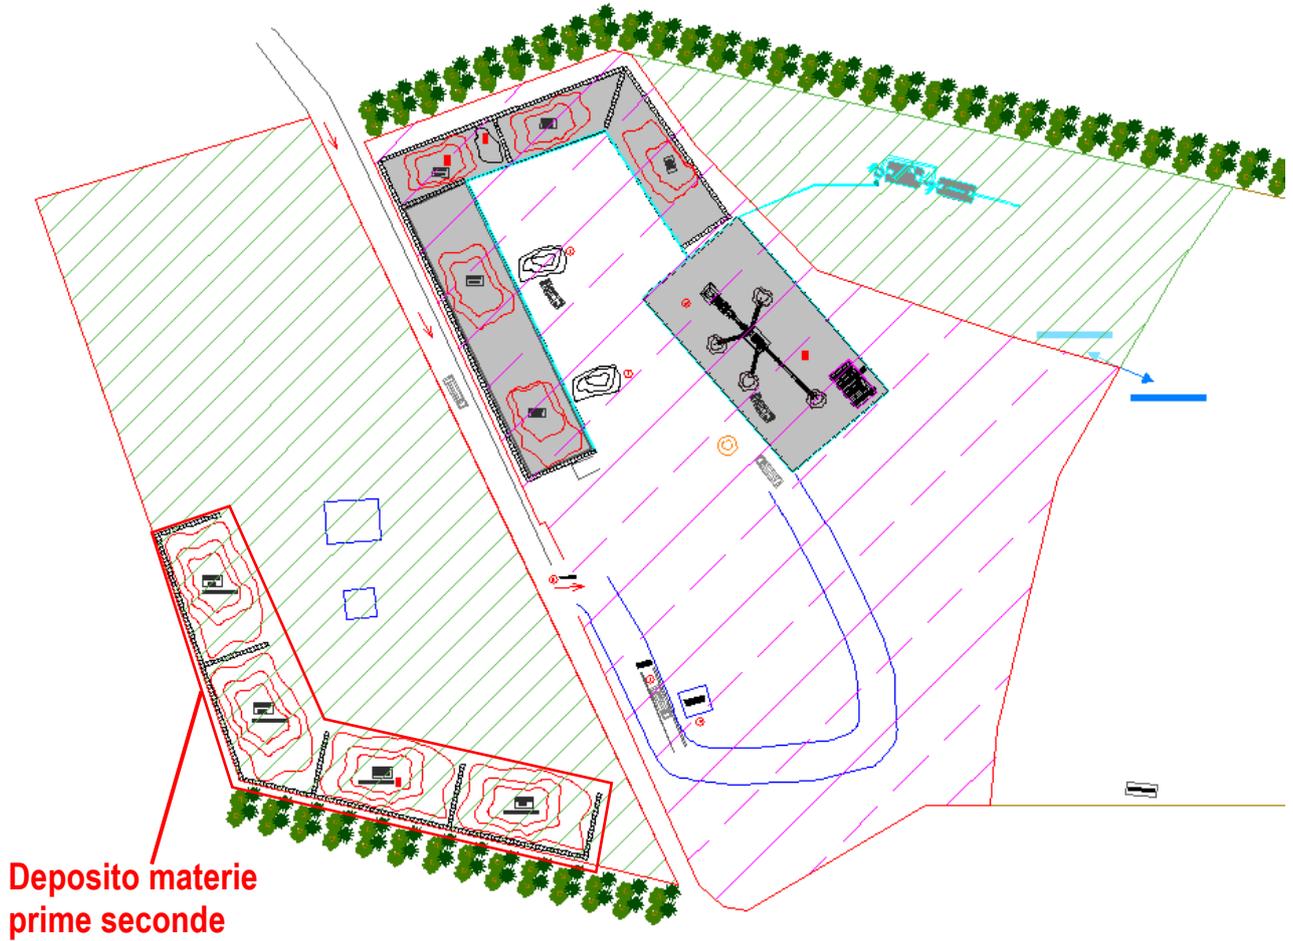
Planimetria impianto con zonizzazione PRG Comune Sant'Elpidio a Mare
